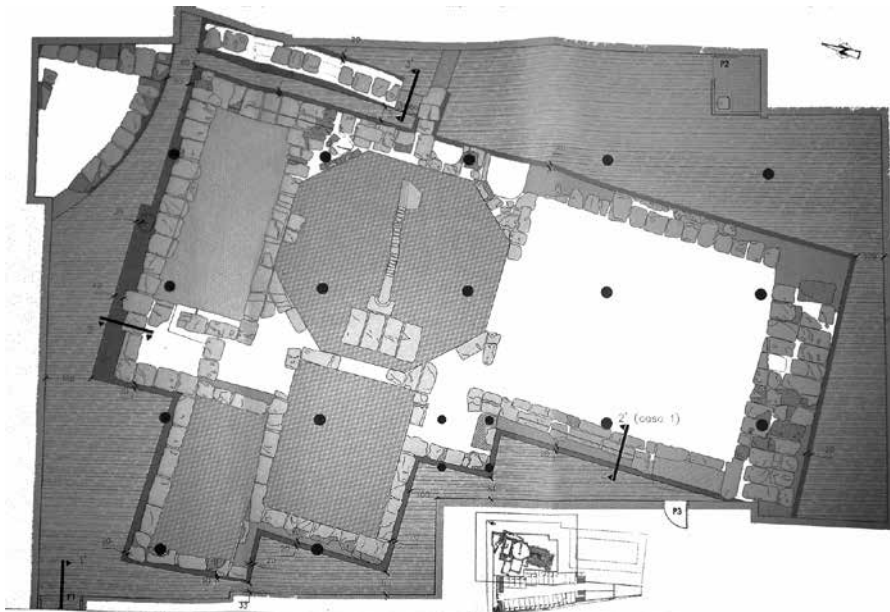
Planta general. Plano sin escala. Arquitectos M^a Carmen Chacón Guerrero y Jerónimo Sanz Cabrera
